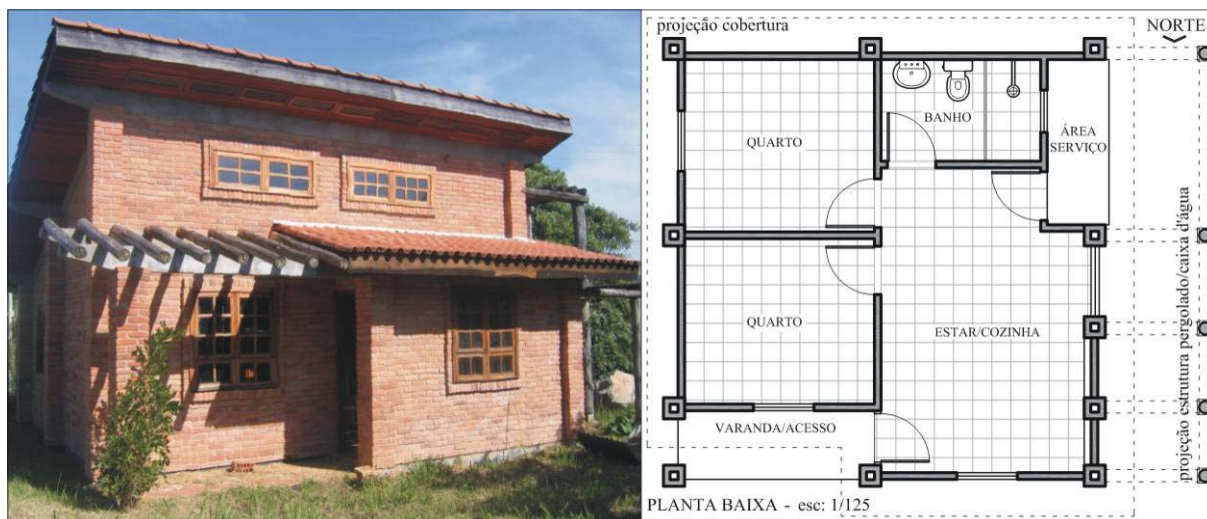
Vista norte e planta baixa do Protótipo Alvorada
